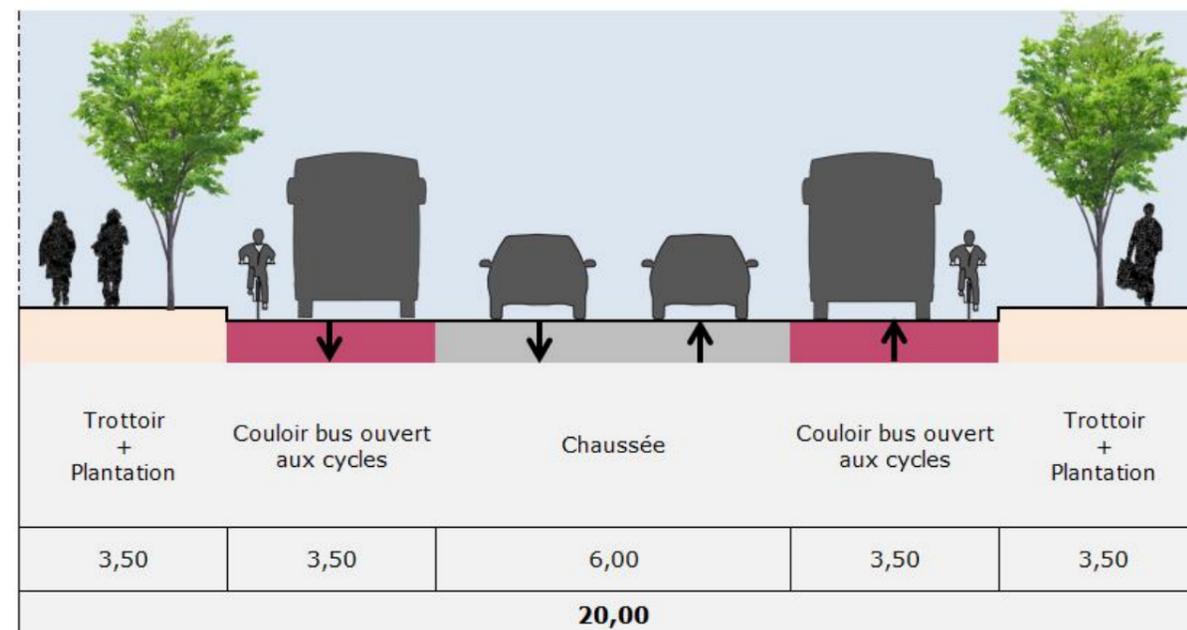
Coupe type pour l'insertion d'un site propre bilatéral
